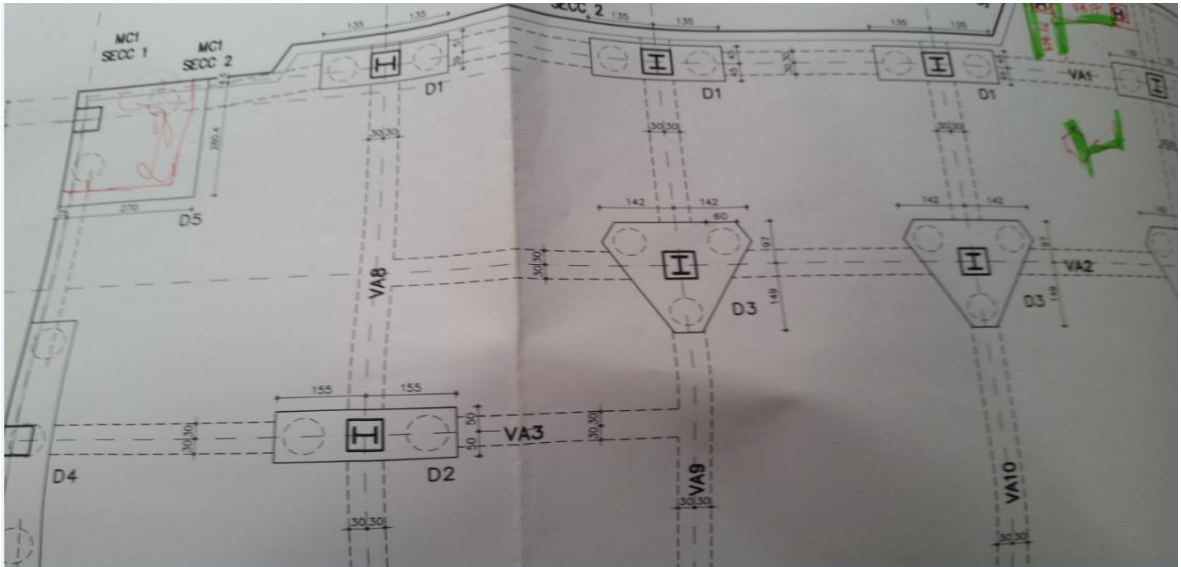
PLANTEAMIENTO INICIAL PLANTA DE CIMENTACIÓN.
